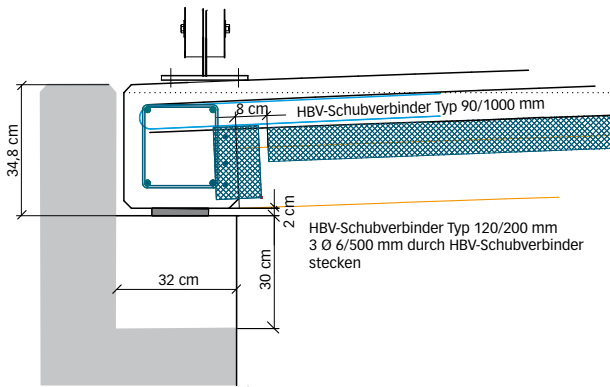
Kraftweiterleitung über stirnseitig in die Holzelemente eingeklebte HBV-Schubverbinder. Bewehrungsführung im querlaufenden Stahlbetonauflegerbalken (aus [1]).
